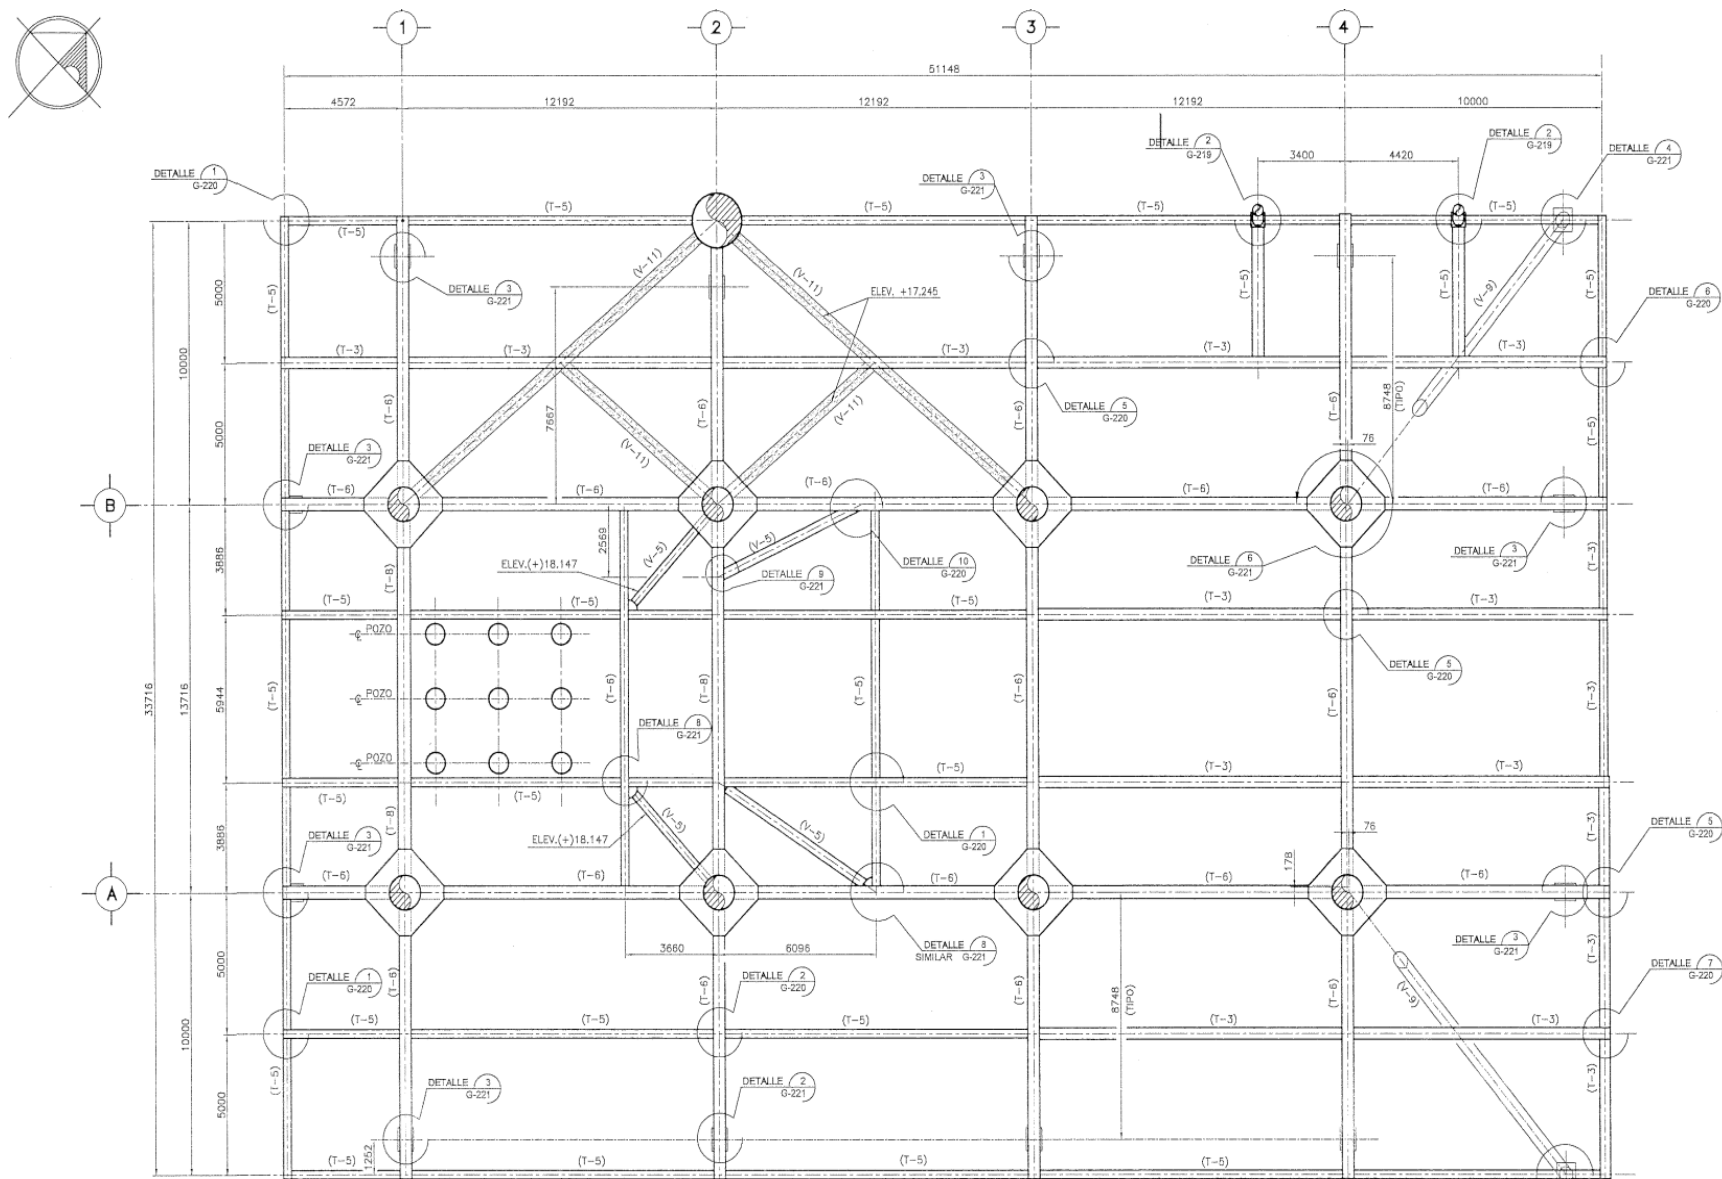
Planta estructural de la cubierta inferior en elev. +18.643m de la plataforma marina ONEL-A
